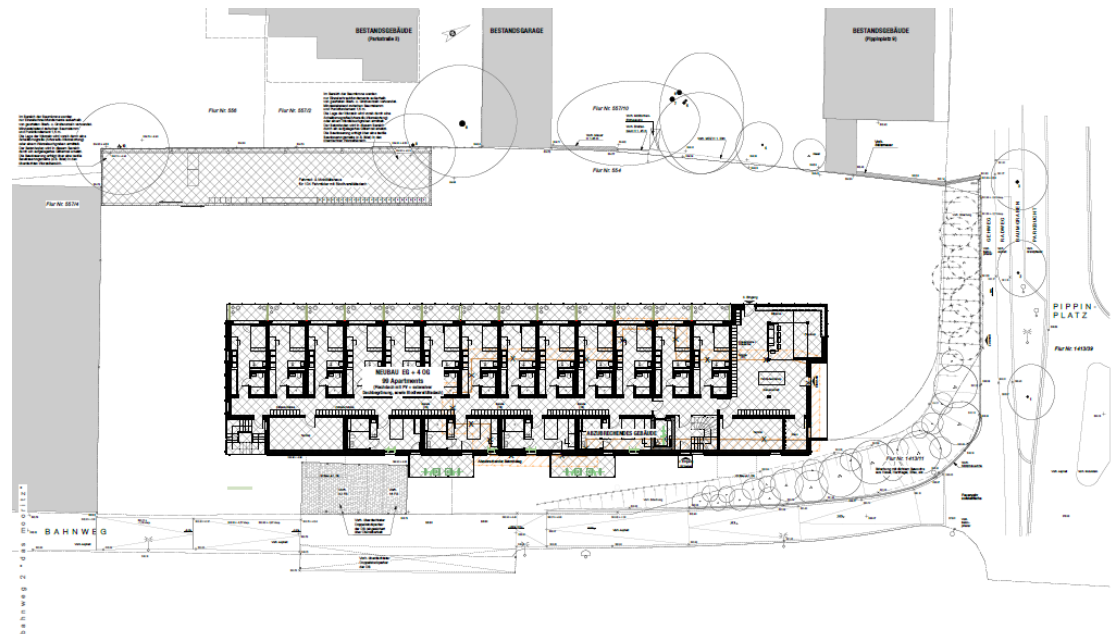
Baumbestandsplan 02.12.2025. Quelle: Samy Freiraumarchitektur
